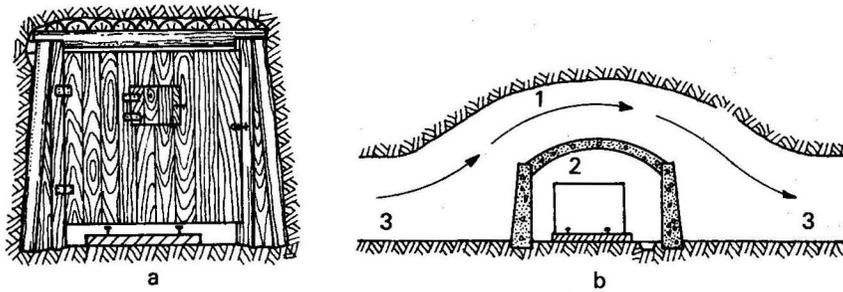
Construcciones para la ventilación de las minas: a) puerta de ventilación; b) puente de ventilación; 1, puente; 2, galería de transporte; 3, galería de ventilación
